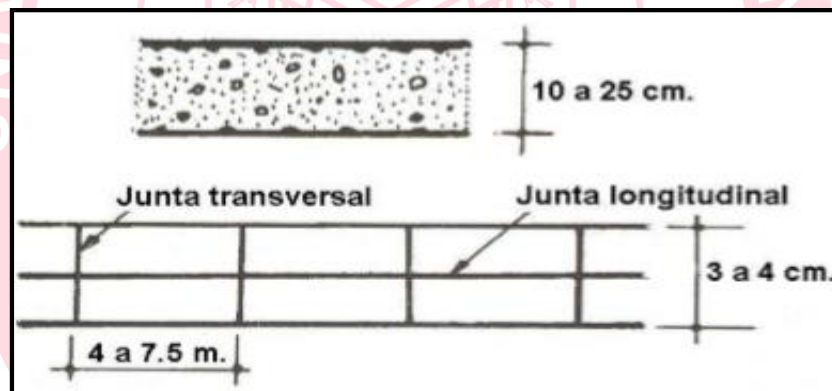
Pavimento de concreto simple sin elementos de transferencia de carga.
